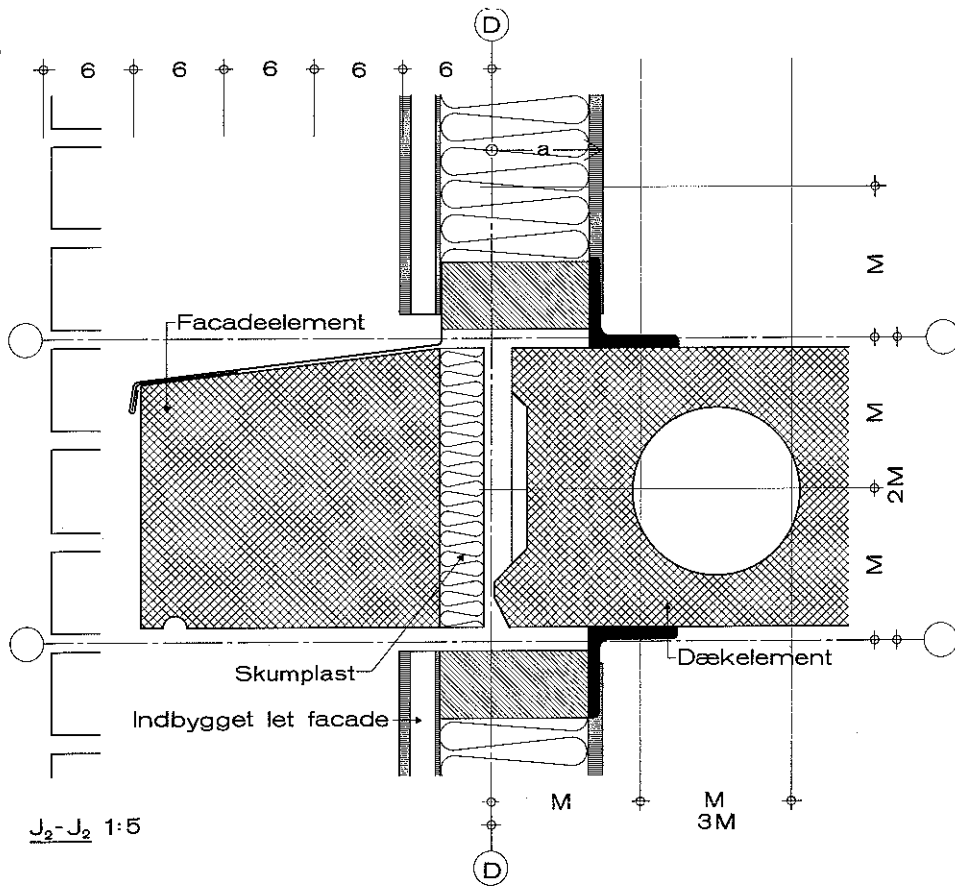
Dæk - let facade - vandrette og lodrette facadebånd.
